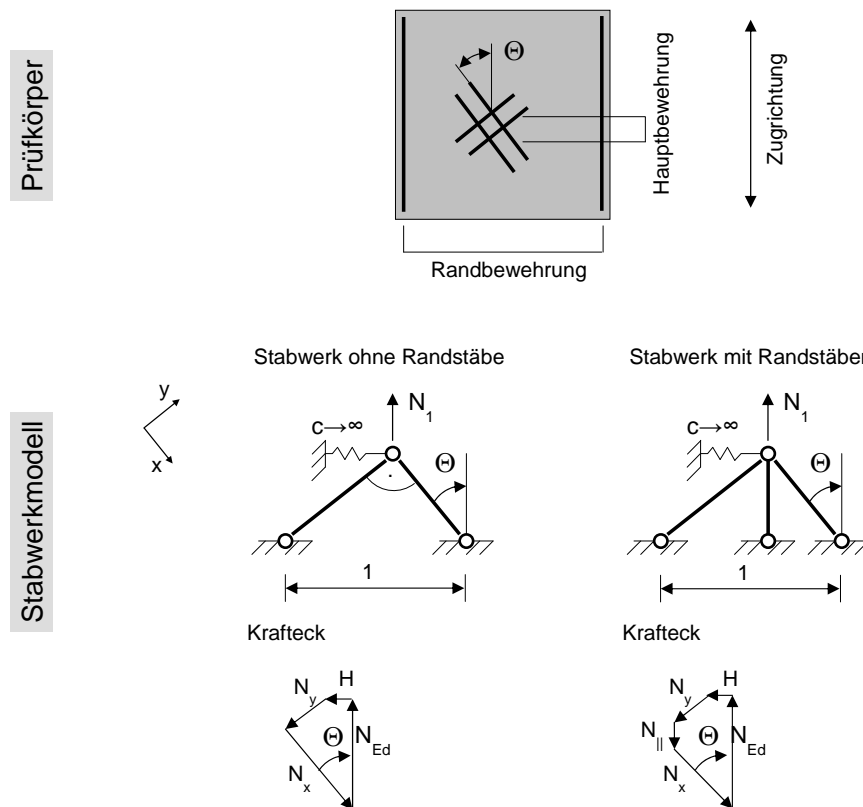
Stabwerkmodell zur Ermittlung der Stahlspannungen
